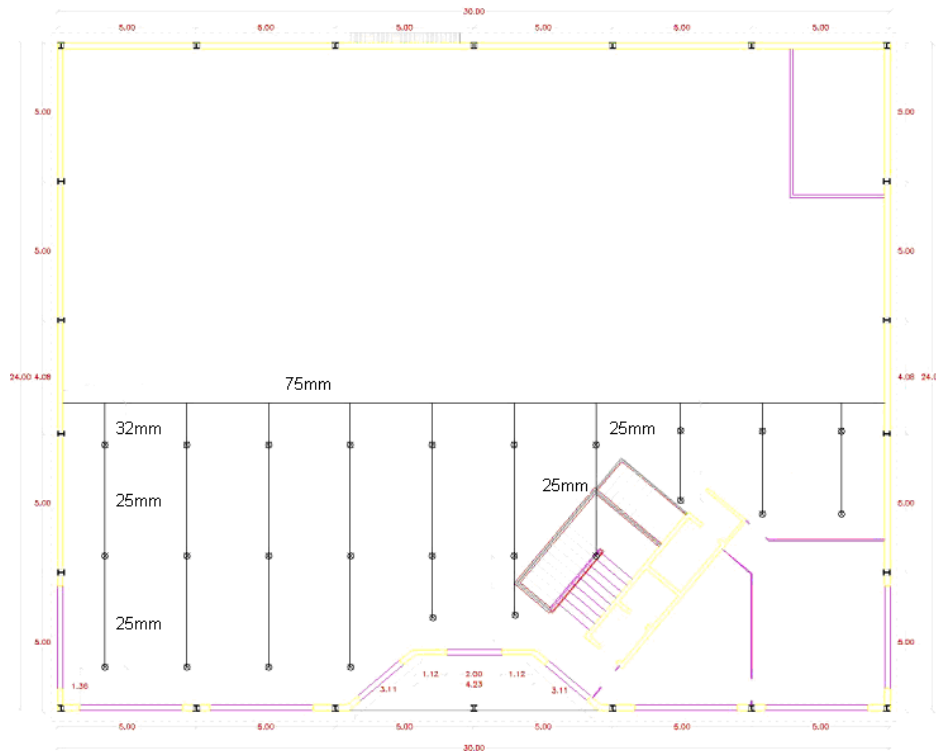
Diâmetros das tubagens da rede de sprinklers da sala do segundo piso
